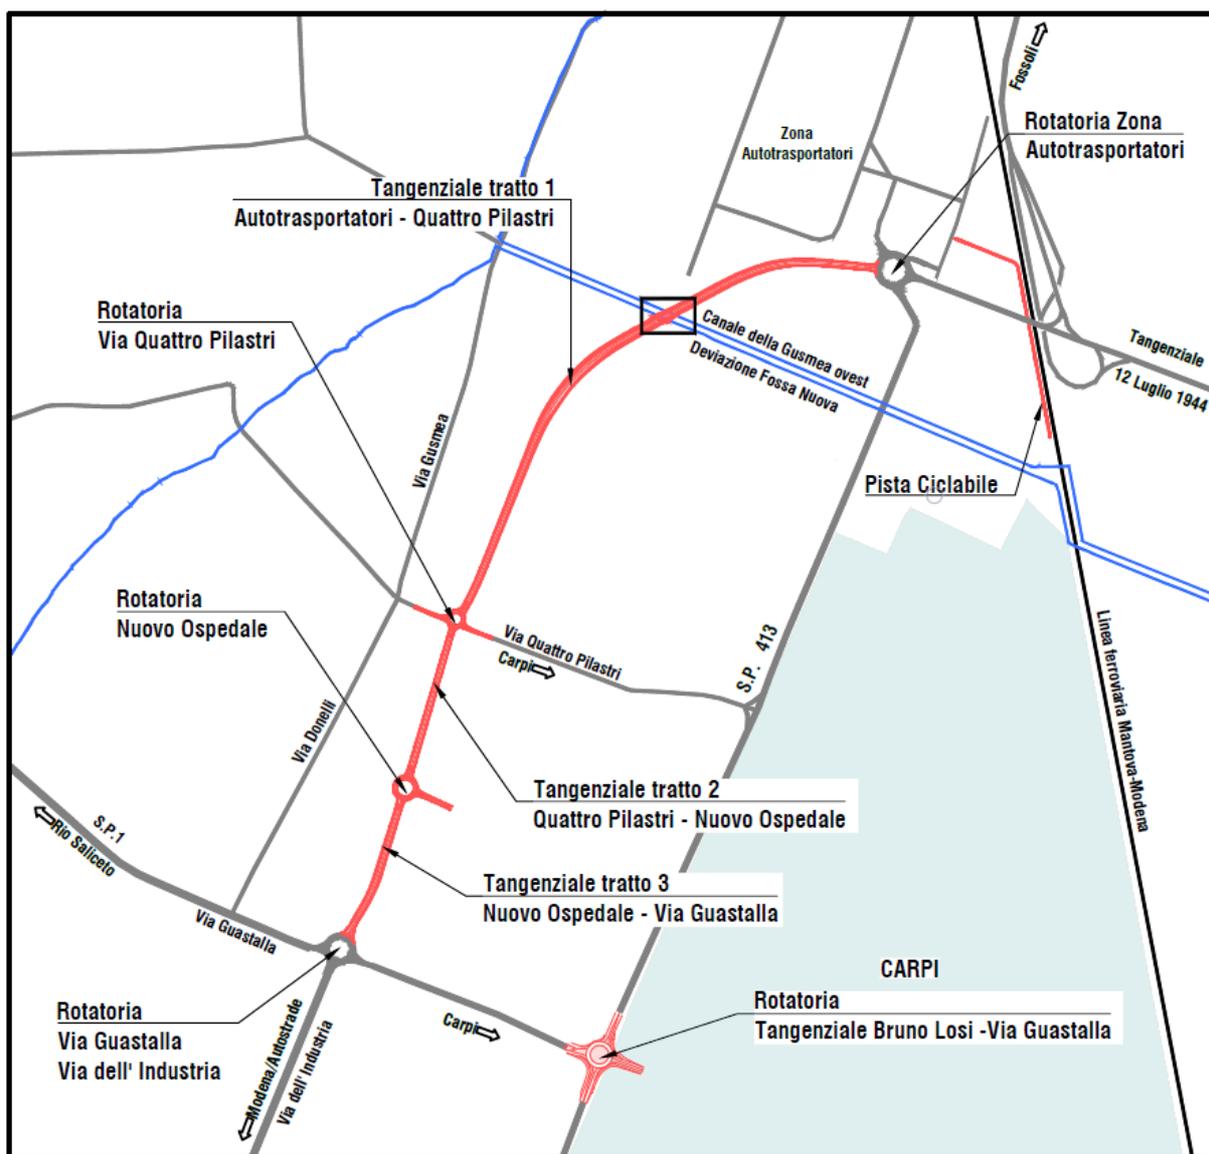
Planimetria generale: inquadramento delle opere maggiori.
